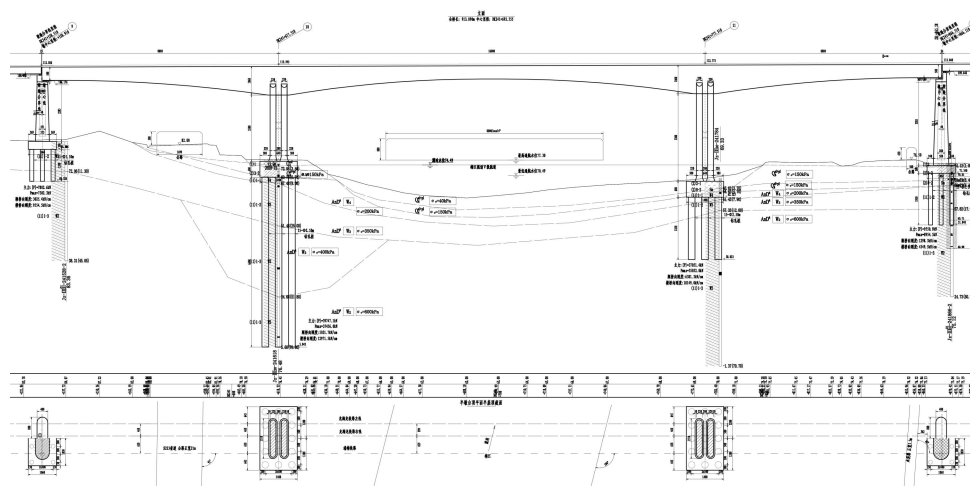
梅江特大桥主跨 160m 连续刚构跨越梅江立面布置图
